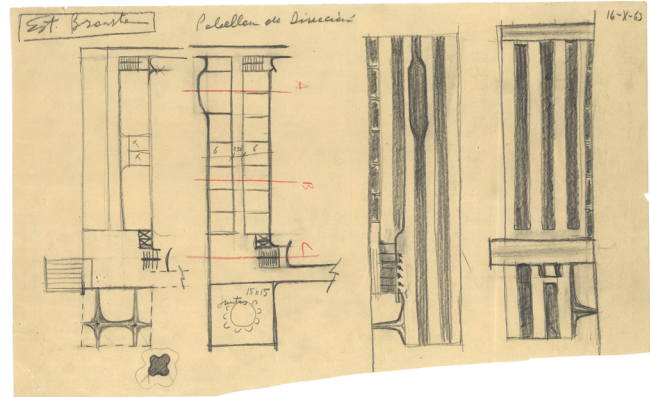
Estudios Bronston. Croquis de plantas y alzados. Fundación Fisac.
